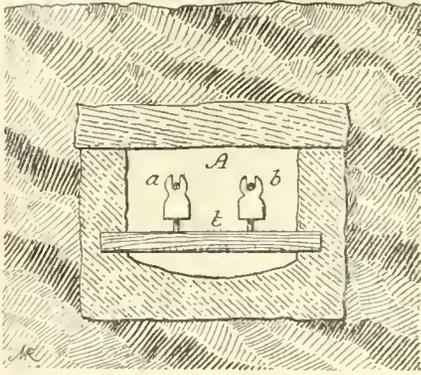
Coupe d'un caniveau pour ligne souterraine.
